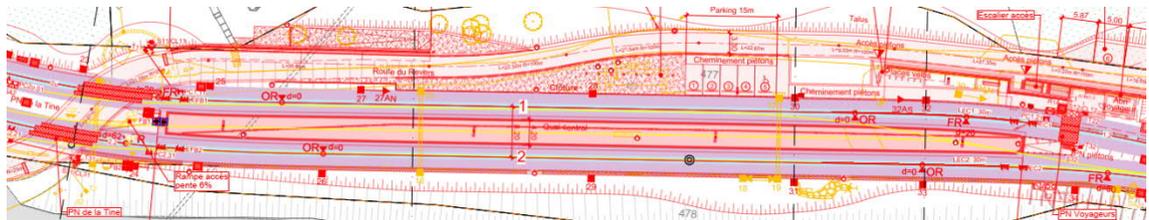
Plan de situation de la gare (pièce 12.2.1 du dossier PAP).
